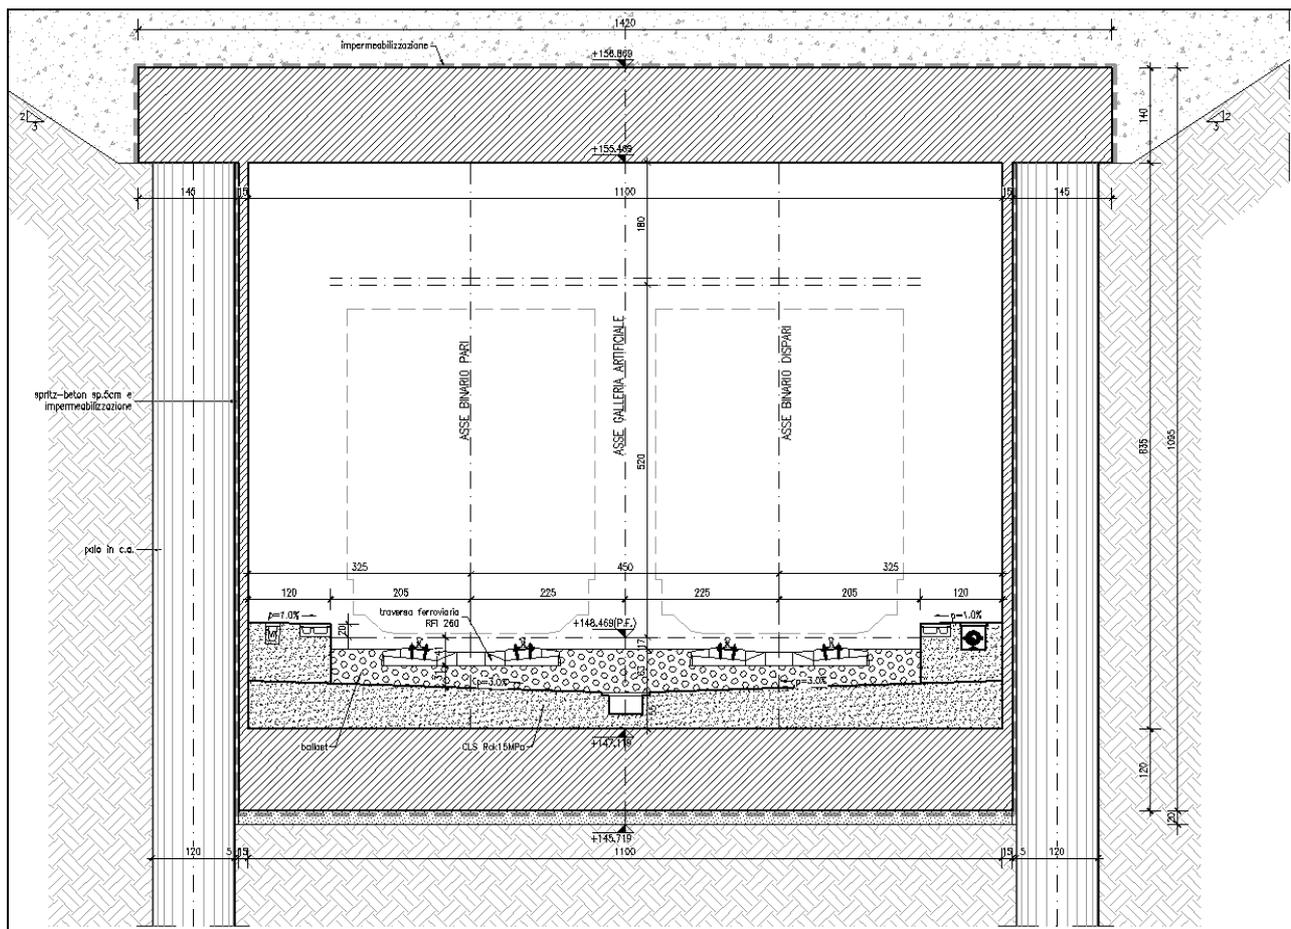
Sottopasso ferroviario. Sezione trasversale sezione corrente
